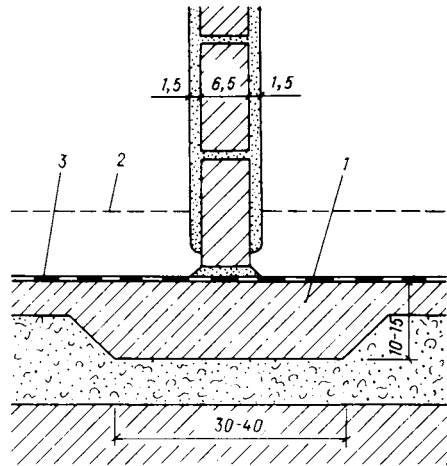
Усиление нижнего слоя бетона под перегородкой из четвертей кирпича
